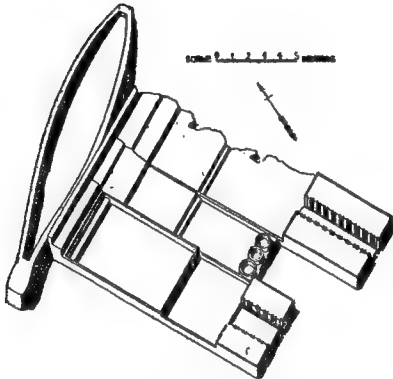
مسقط أفقي للقبرة ٣٣٥٨ في سقارة
